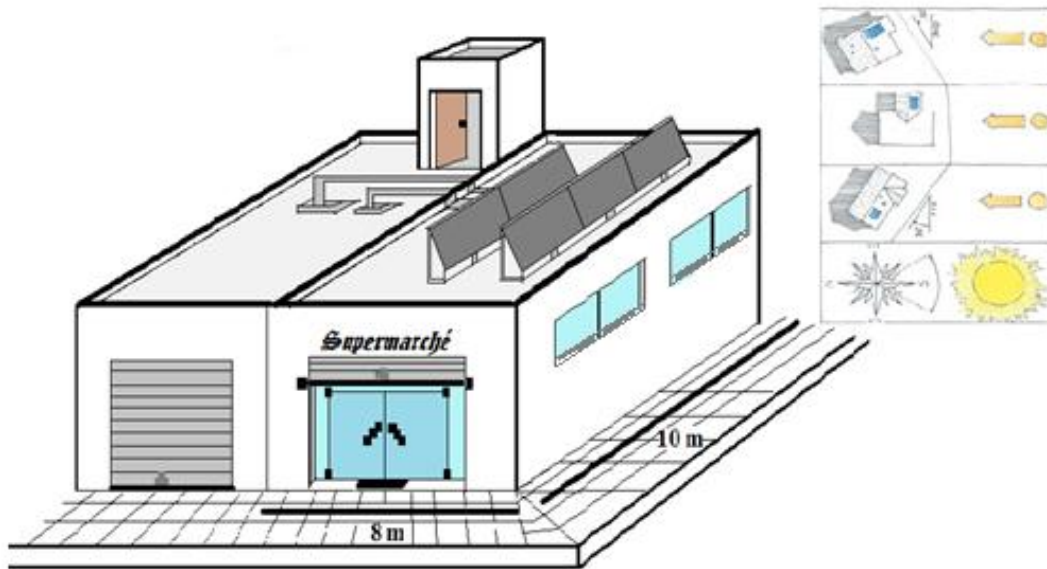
Illustration de l'installation des capteurs solaires plans sur la toiture du local.
